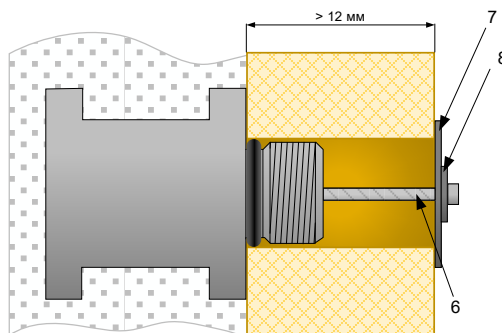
Крепление анкера при толщине щита опалубки более 12 мм
